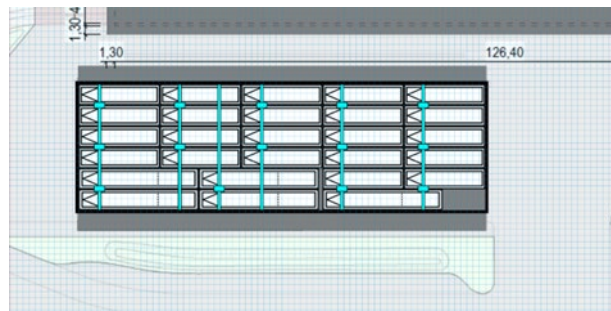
Planausschnitt Abstellhalle für BEV mit sechs Spuren
